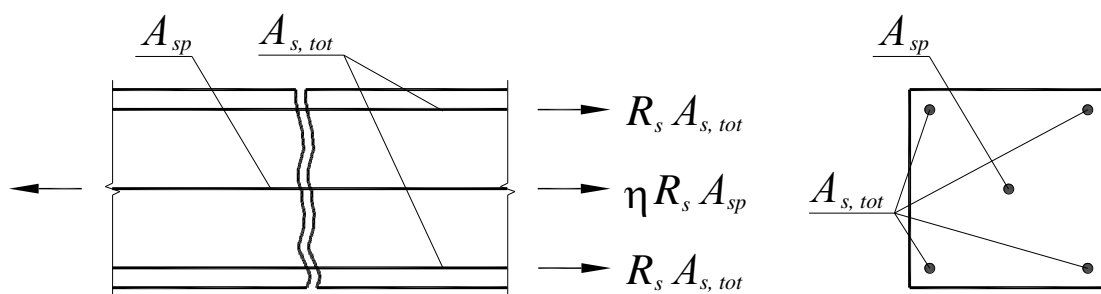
Предварительно напряженный железобетонный элемент при центральном растяжении.
